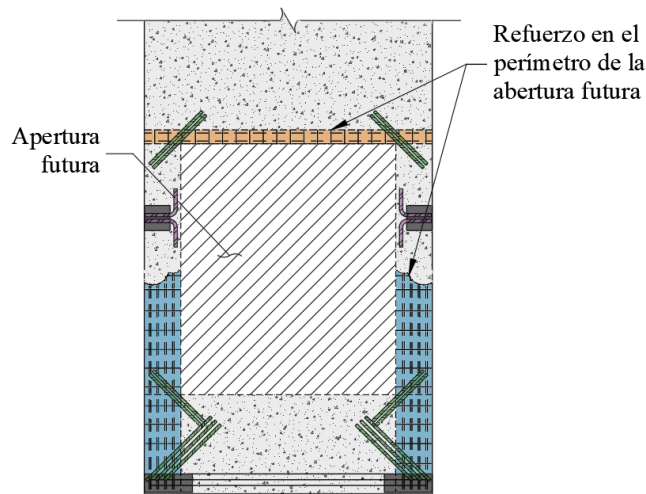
Refuerzos perimetrales por colocar en los huecos que podrán demolerse en el futuro
